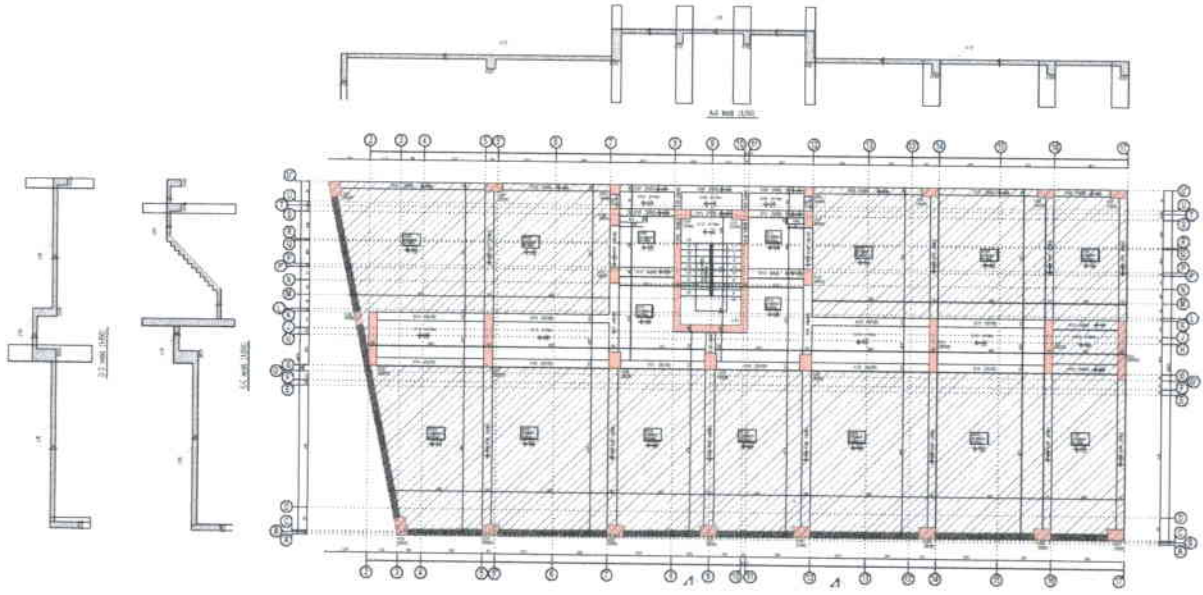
A1 blok Zemin-7.Kat Kalıp Planı
